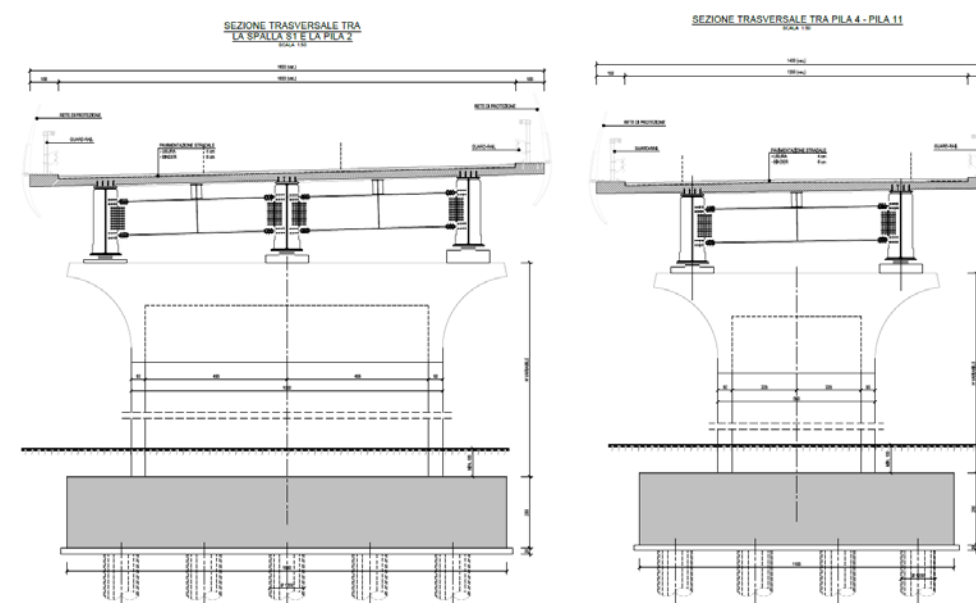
Viadotto Serra Paducci Rampa 8: sezione impalcato/pile (le due tipologie)
